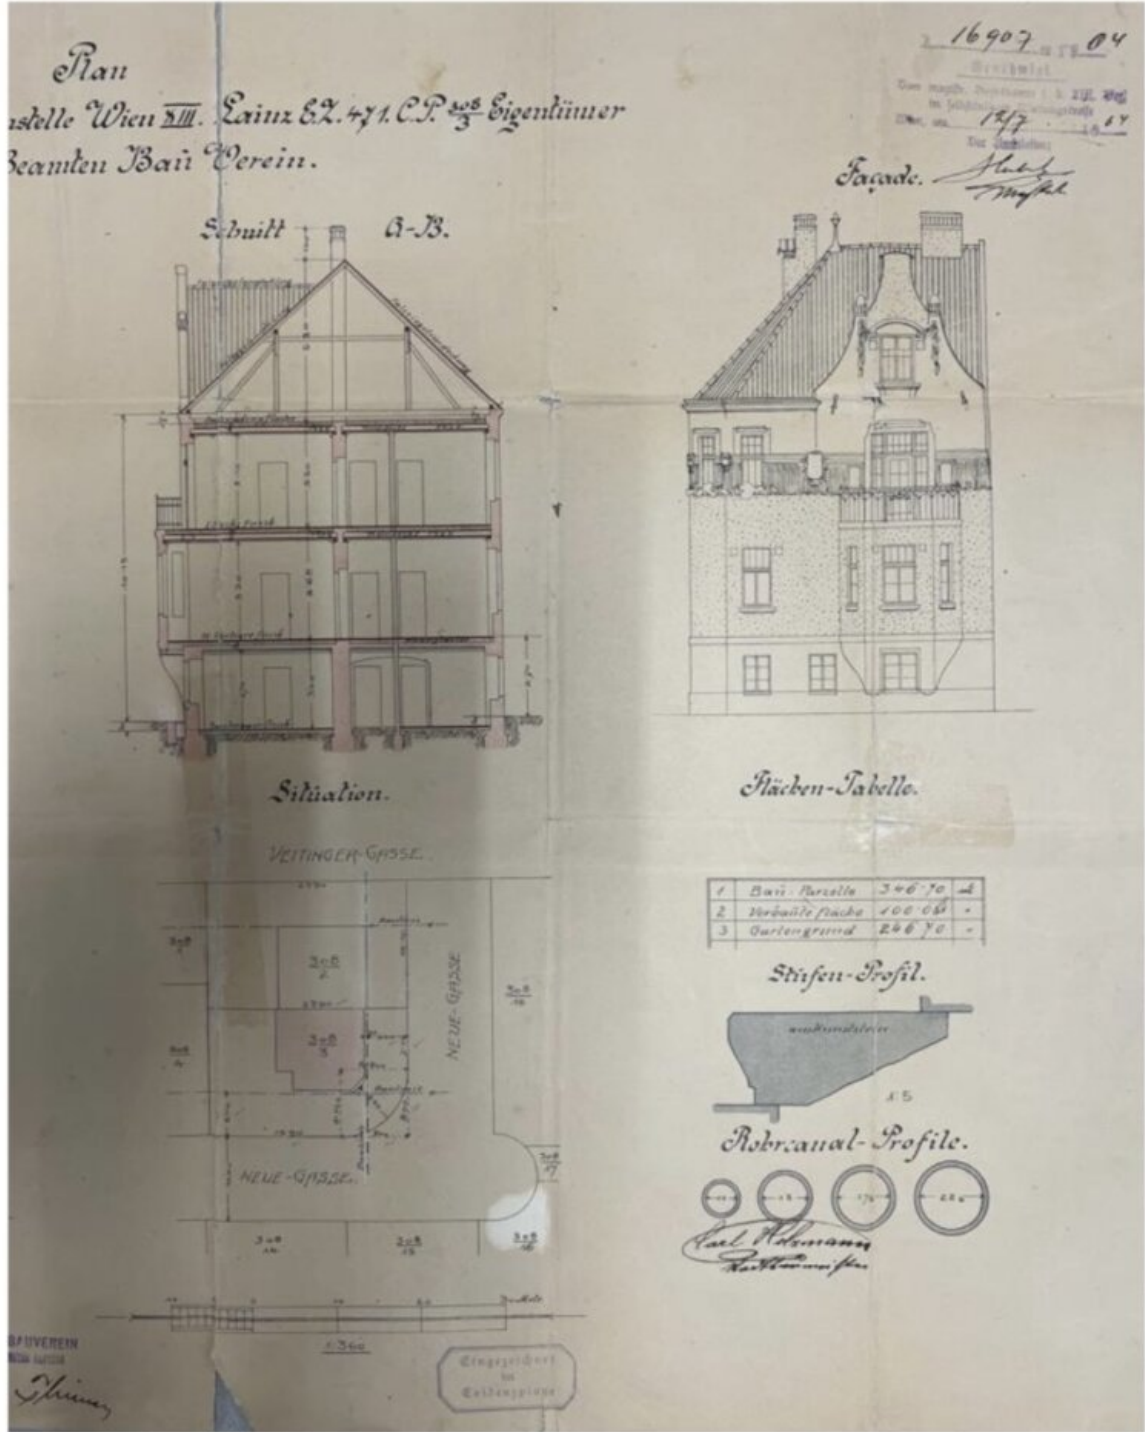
Erbauungsplan 1904, Lageplan, Schnitt und Straßenansicht
